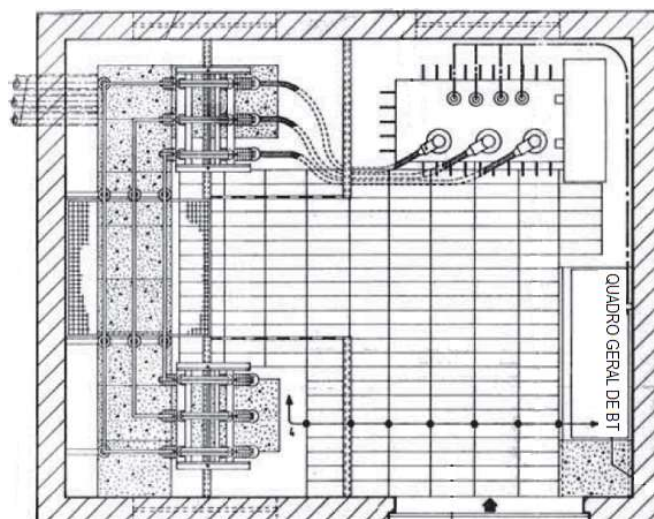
Planta de PT tipo CBU de construção tradicional [12]
